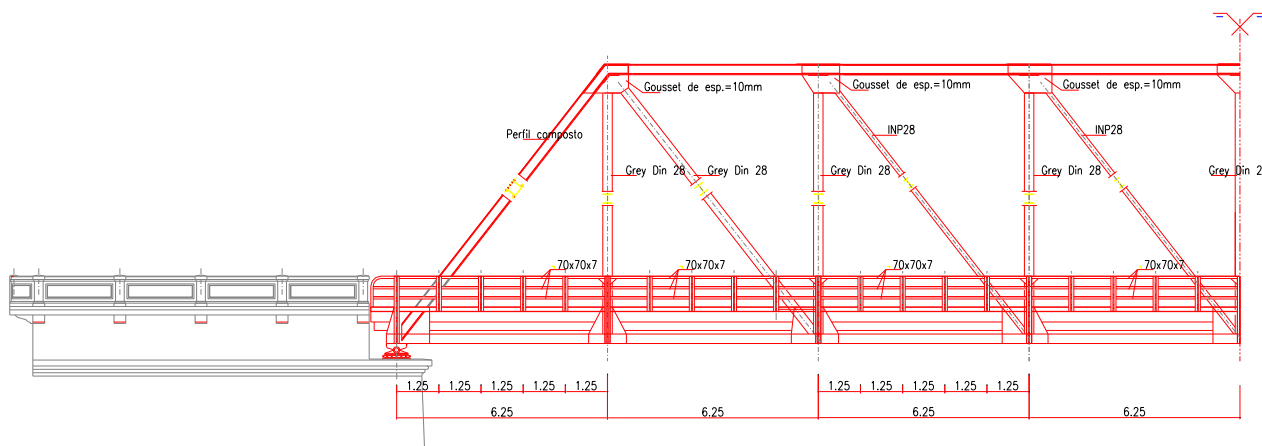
Alçado Longitudinal das treliças (Fonte: Estradas de Portugal)
